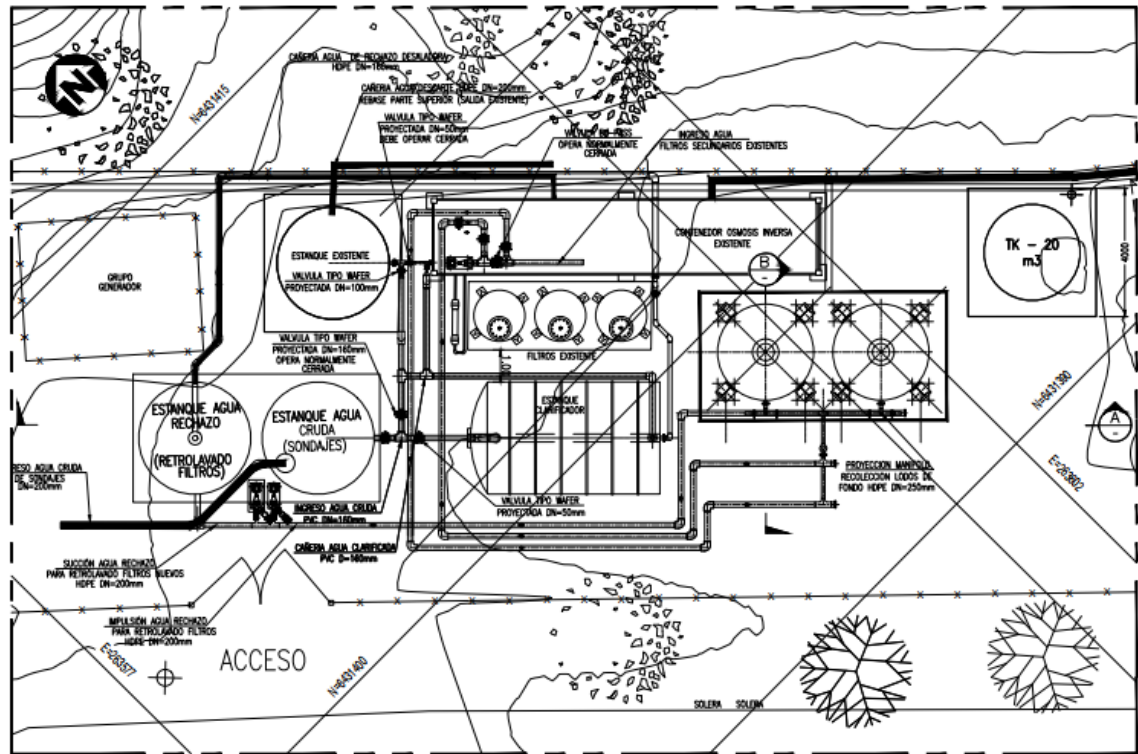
Disposición equipos planta potabilizadora Los Molles
